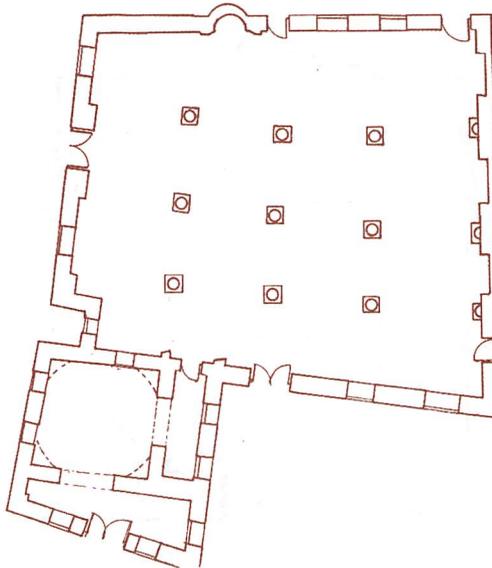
المسقط الأفقي لقبة وضريح الكوفي بمحلة بشر
